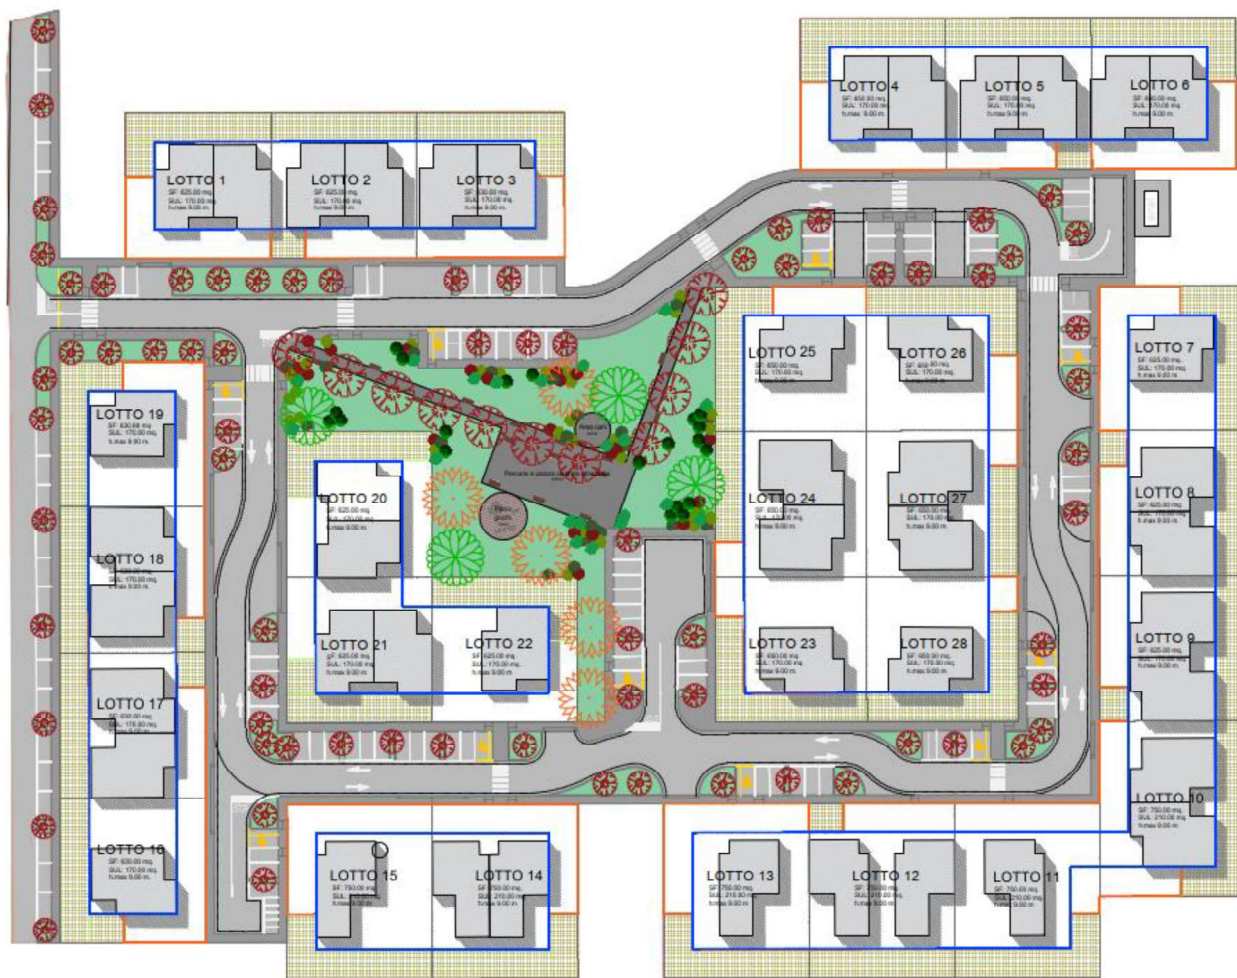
Estratto Planimetria generale - Tavola 7 bis.
